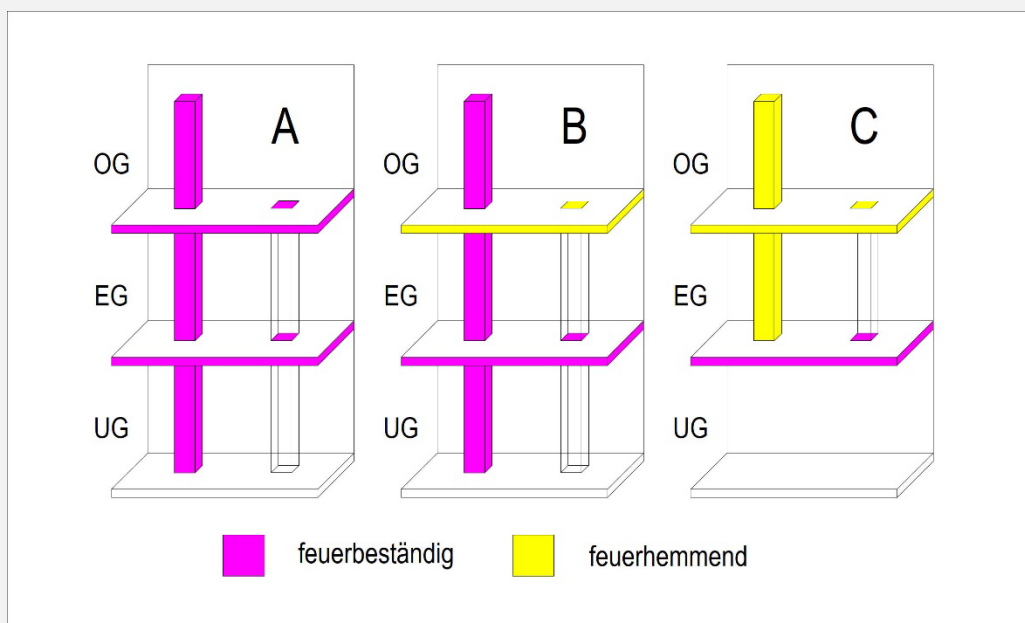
| Grundsystematik Installationsschächte/Geschosstrennung [Quelle: Sinfire GmbH & Co. KG]
